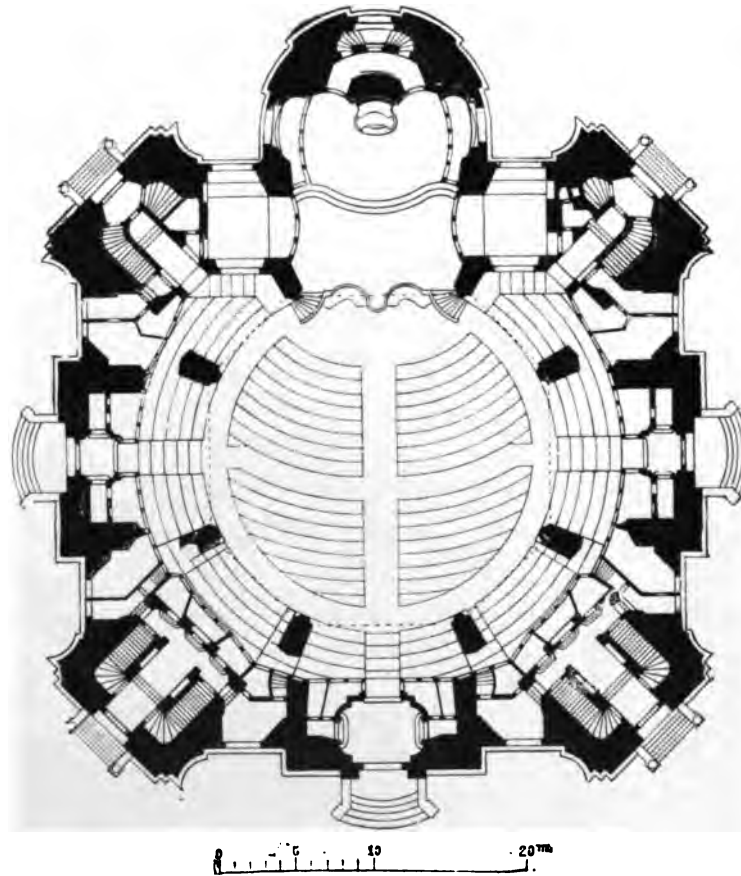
Grundriss der Frauenkirche in Dresden
